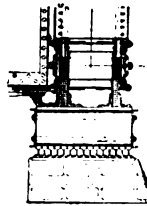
Pont de Burlington. — Travée de 75m,00. — Détails.
